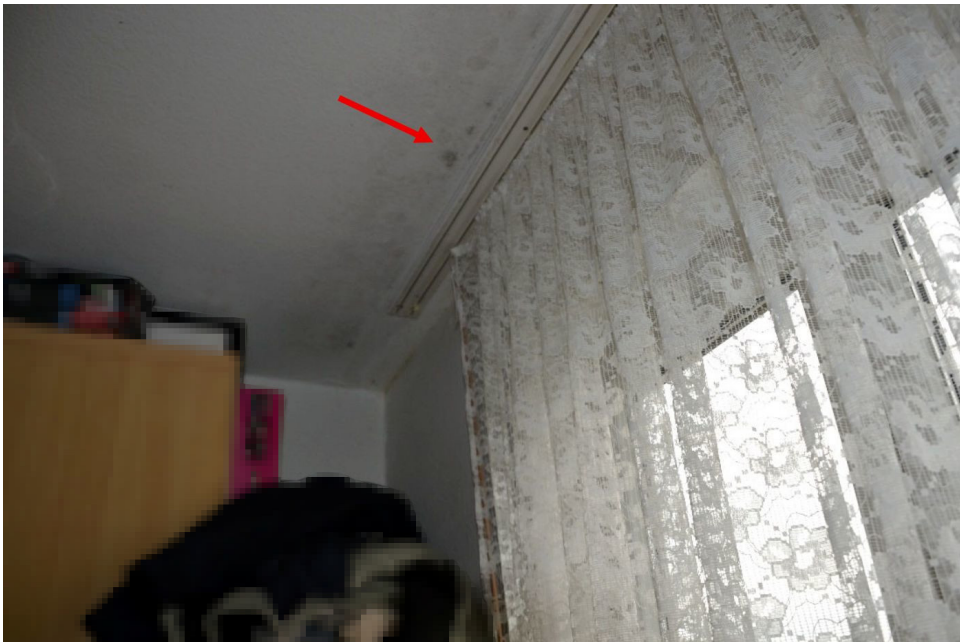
3. Obergeschoss Schlafzimmer, Schimmelpilzbefall
